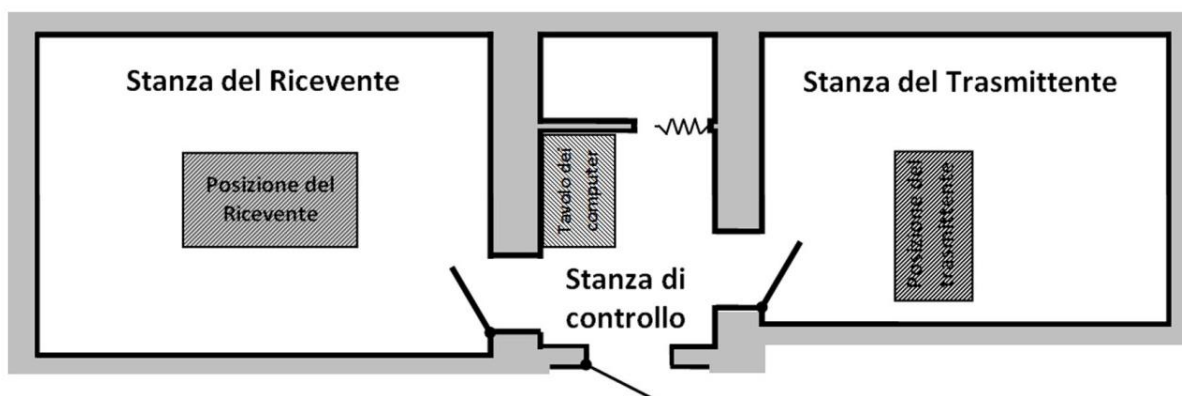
Planimetria schematica del laboratorio di EVANLAB.
